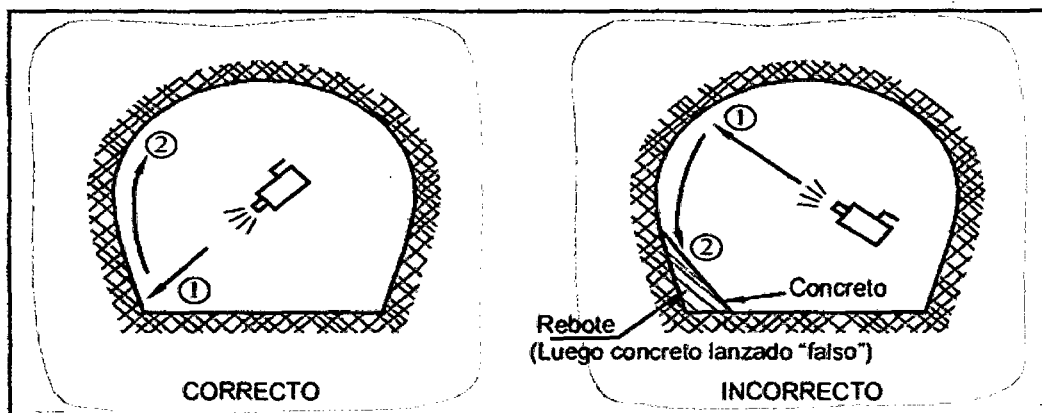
Lanzado correcto e incorrecto del shotcrete (in. Consorcio Minero Horizonte)
